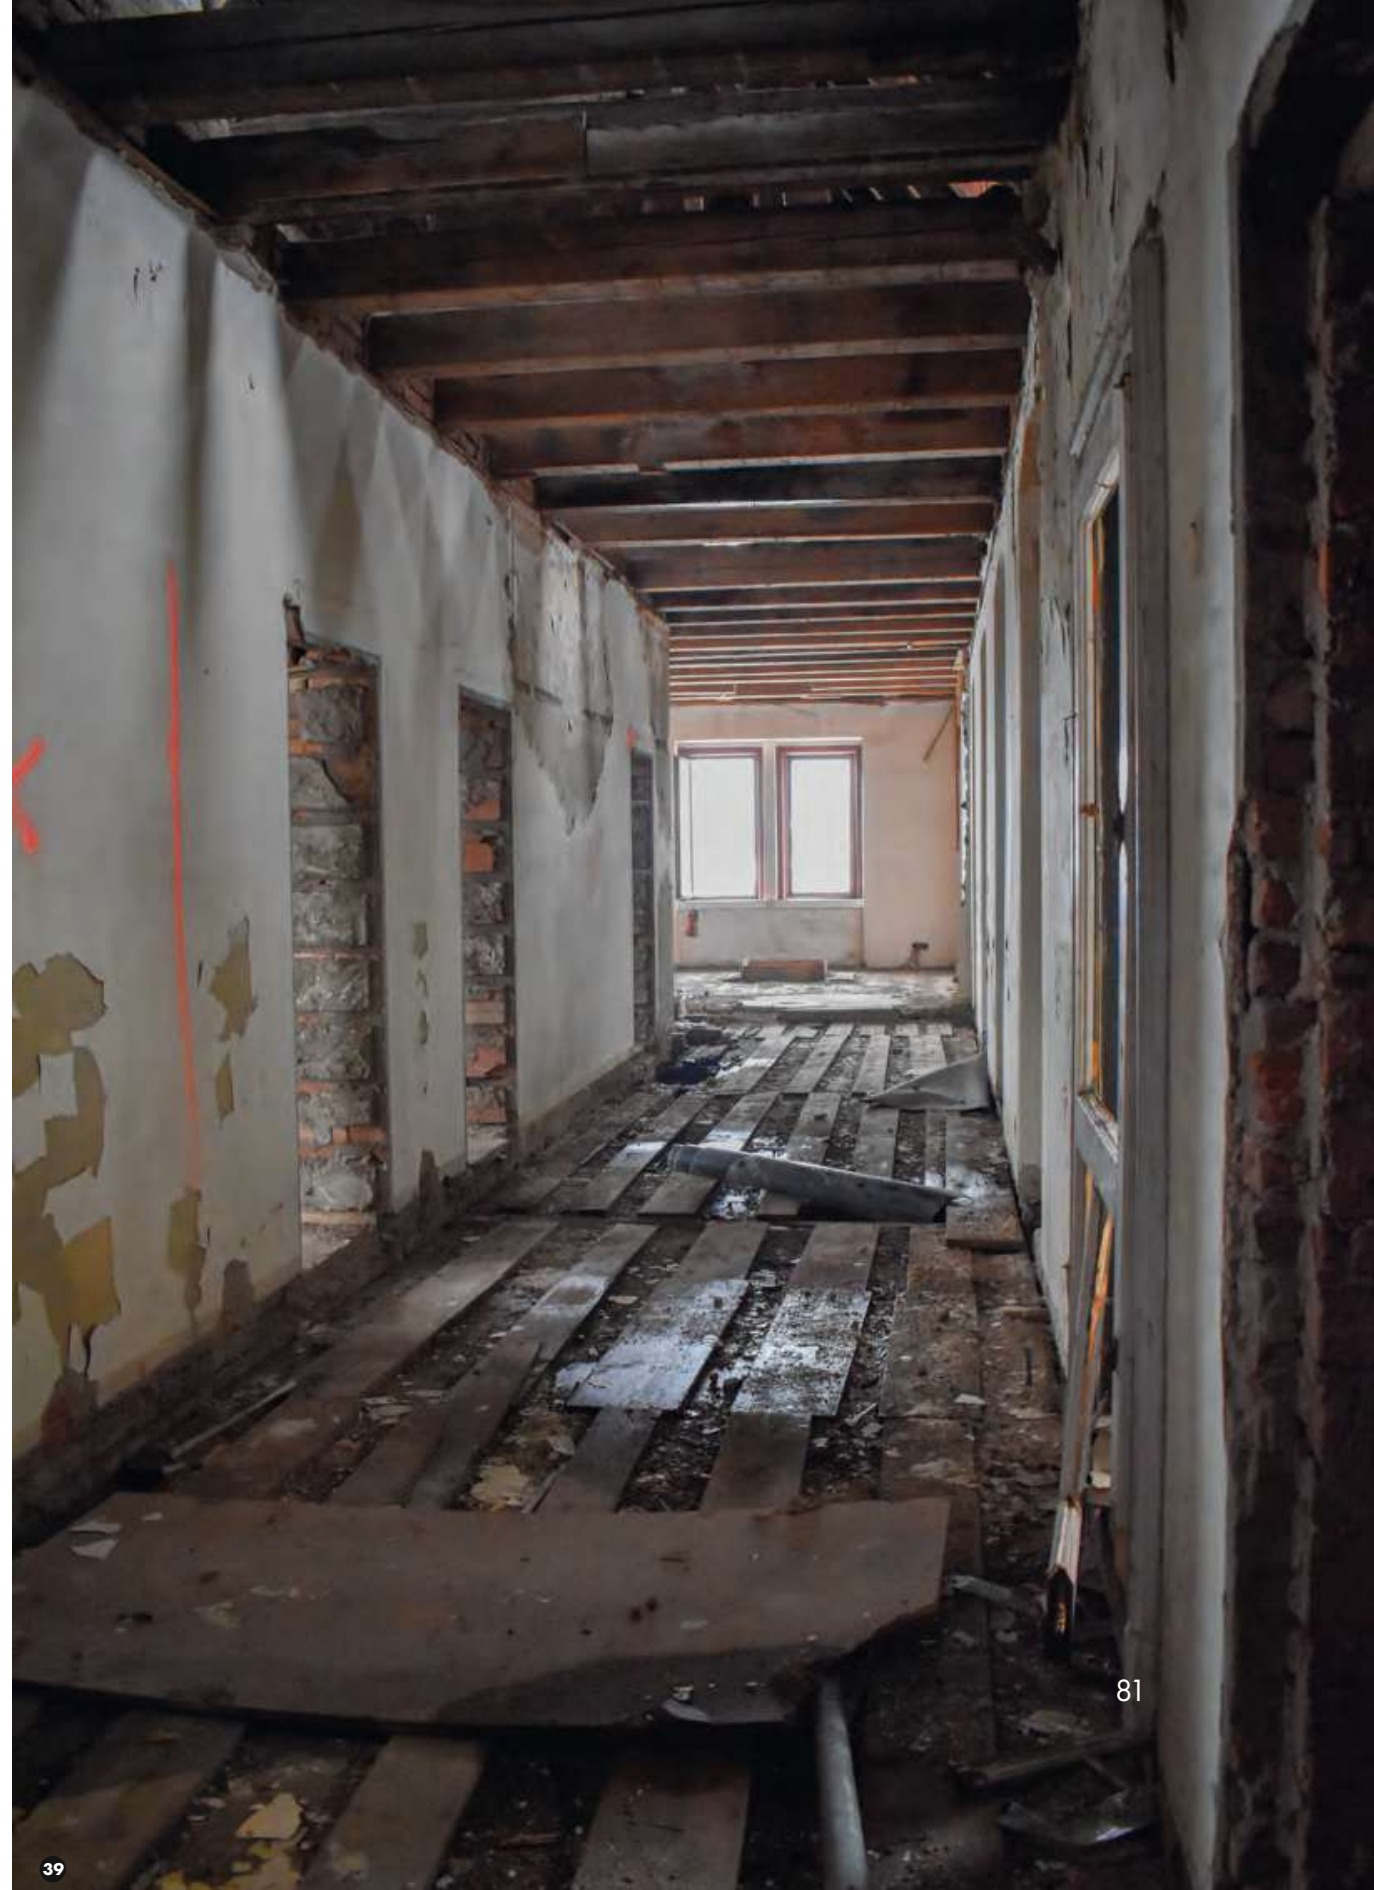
| Fotocollage (27-32); Innenraum 2. Obergeschoss (2021)
